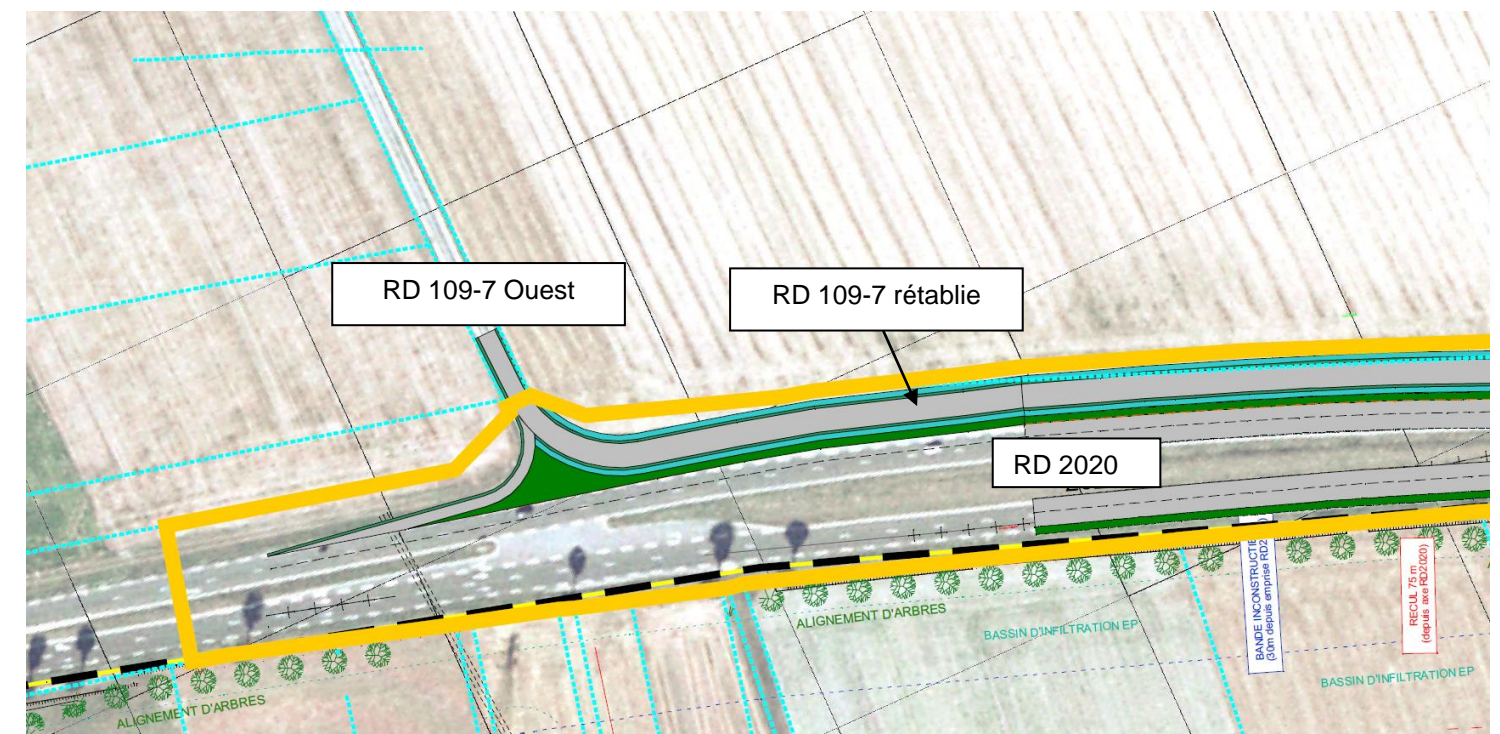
Modification du carrefour plan RD2020/RD109-7 (source : CD 28)
